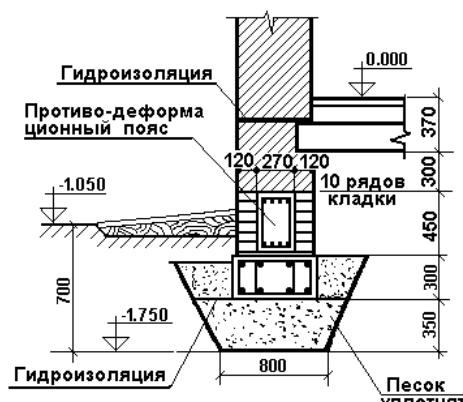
Мелкозаглубленный фундамент на насыпных пучинистых грунтах
